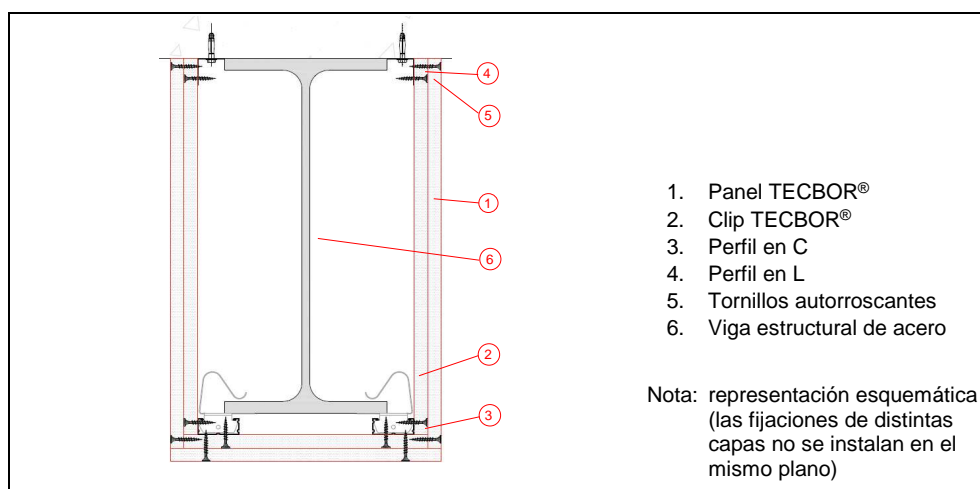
Ejemplo de instalación del sistema de protección contra el fuego (sección de viga).
